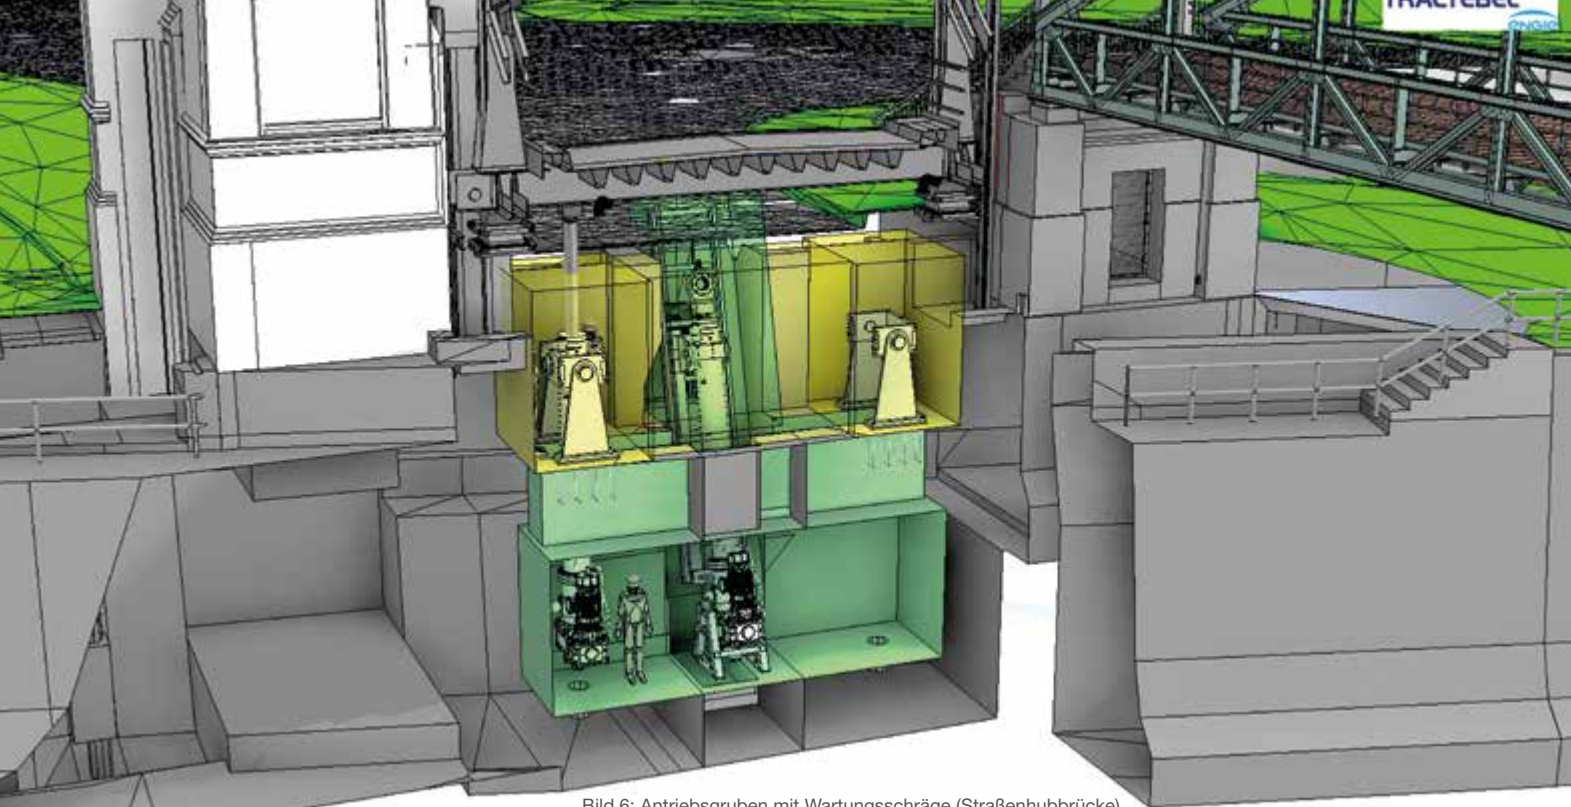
Antriebsgruben mit Wartungsschräge (Straßenhubbrücke)
